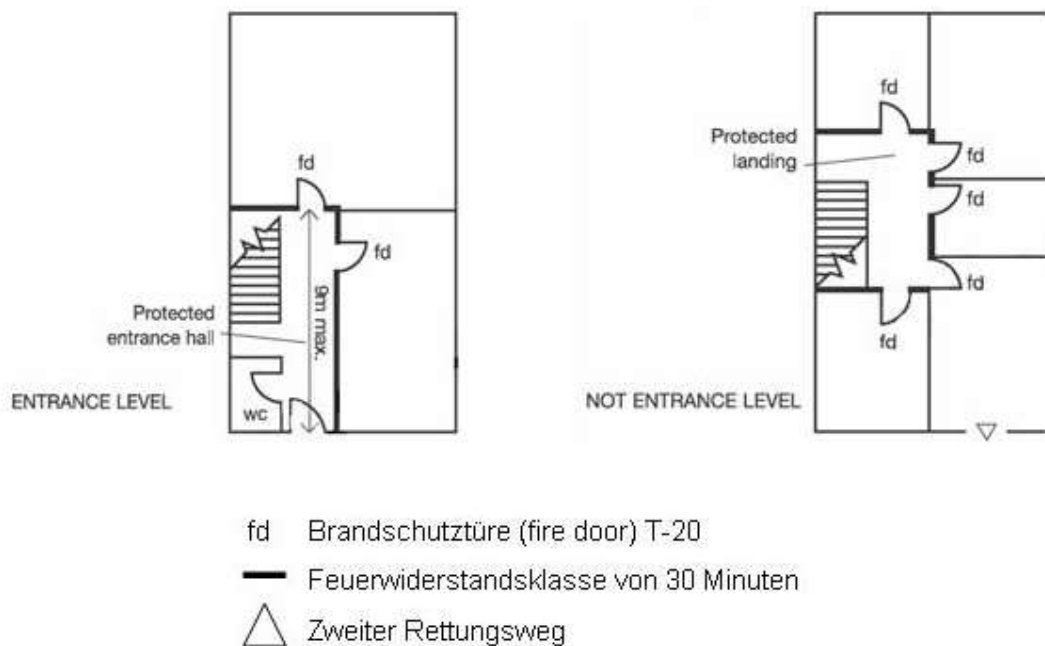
Typische Grundrissgestaltung von zweigeschossigen Wohnungen gemäß Approved Document B
